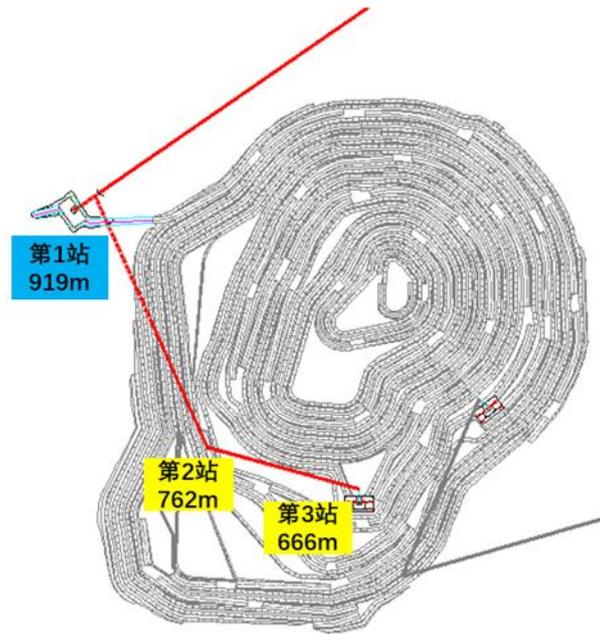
汽车-半移动破碎站-胶带-联合运输平面图
